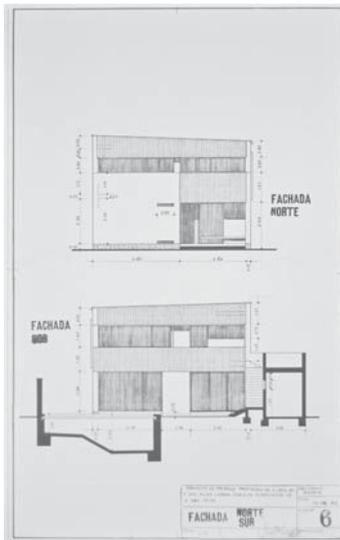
J.A. Corrales. Vivienda Laguna Zabia. Alzados norte y sur. Madrid. 1956. Archivo Corrales
